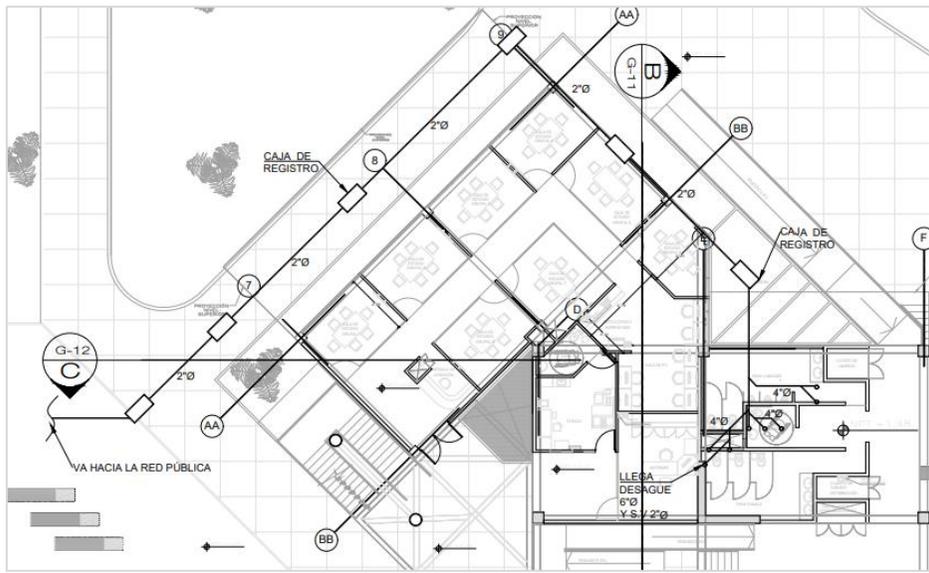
Plano de desagüe sector académico. Autoría propia.
